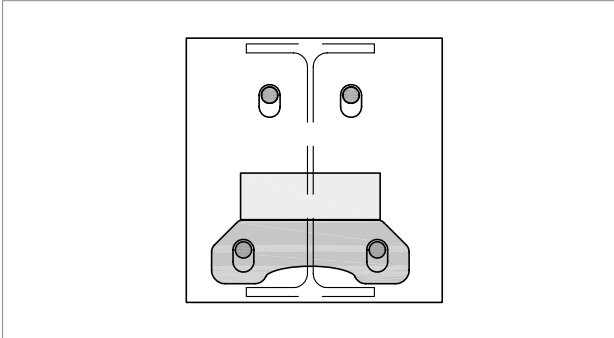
Schöck Isokorb® : raccordement acier – béton armé ; le taquet sur site se trouve directement sur la plaque d'absorption de la charge
